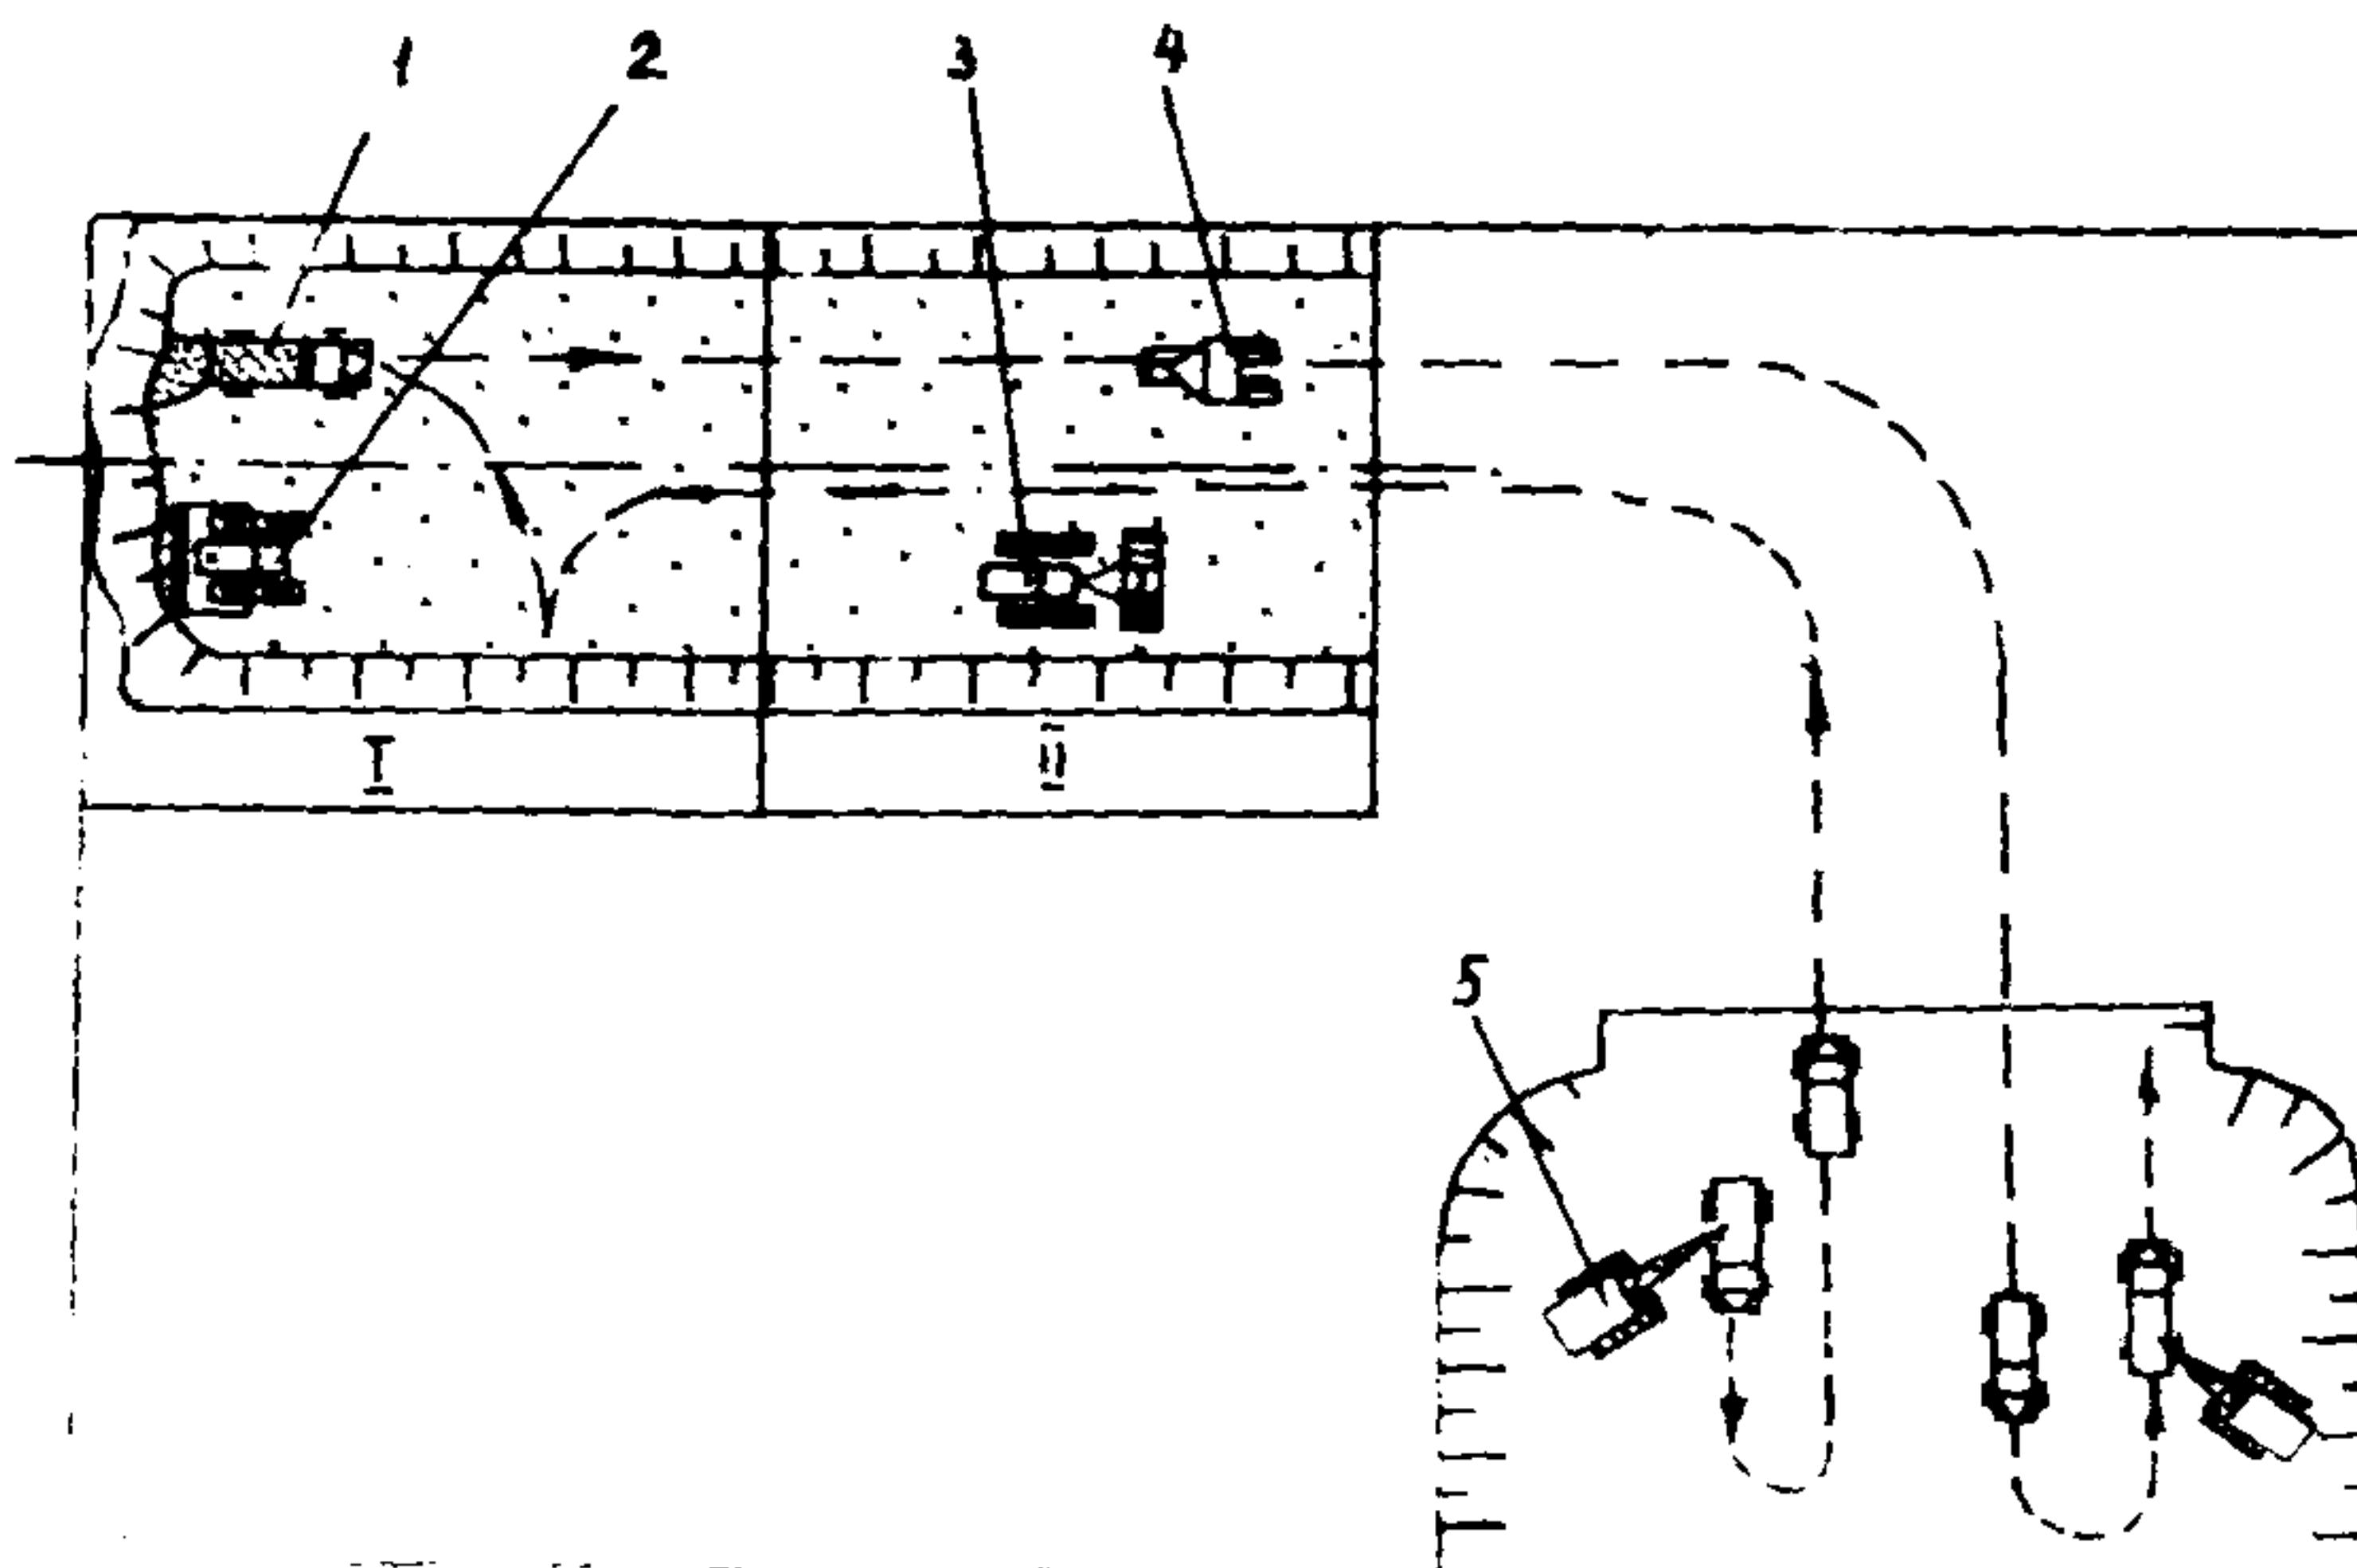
Рис. II. Технологическая схема сооружения грунтовой дороги без покрытия с разработкой грунта в карьерах:
